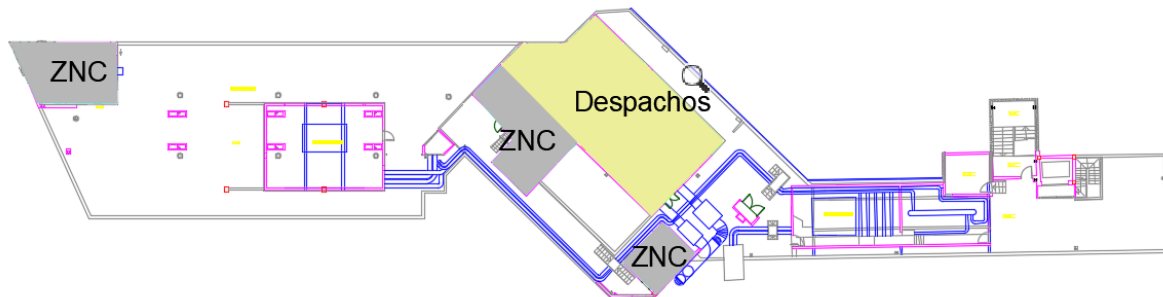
Anexo I. Zonificación planta 5 (fuente: elaboración propia).
